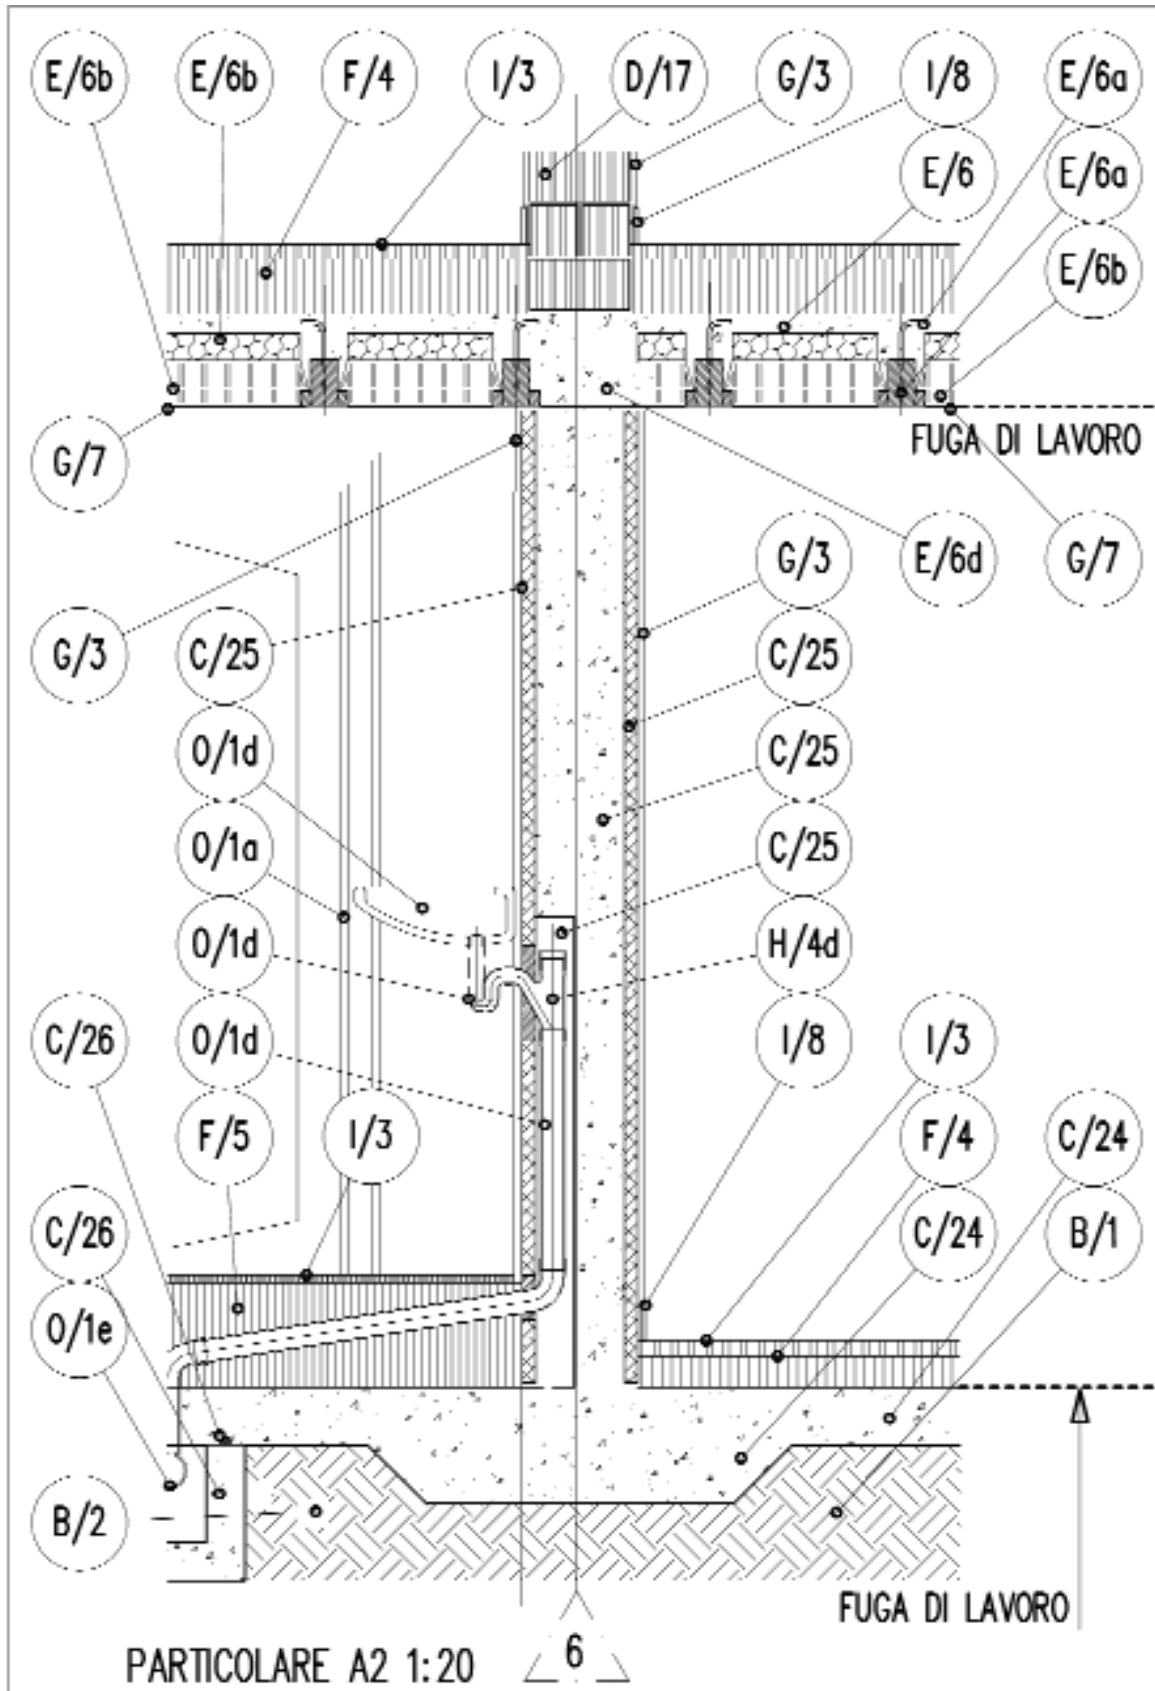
Sezione muro di spina attraverso locale servizio.
